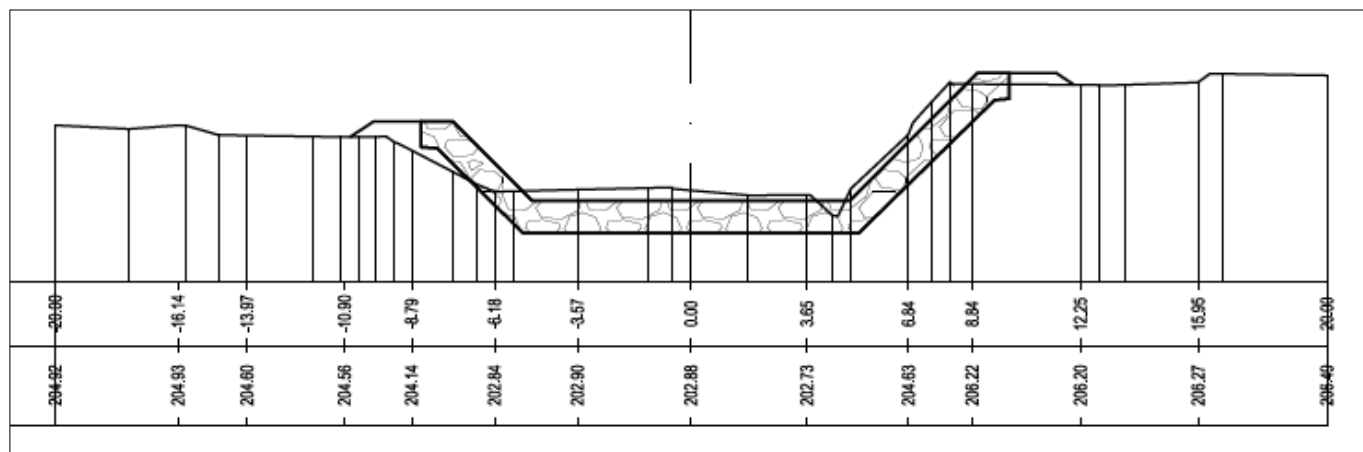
Sezione 1 delle opere di sistemazione idraulica (vd. planimetria in figura precedente).
